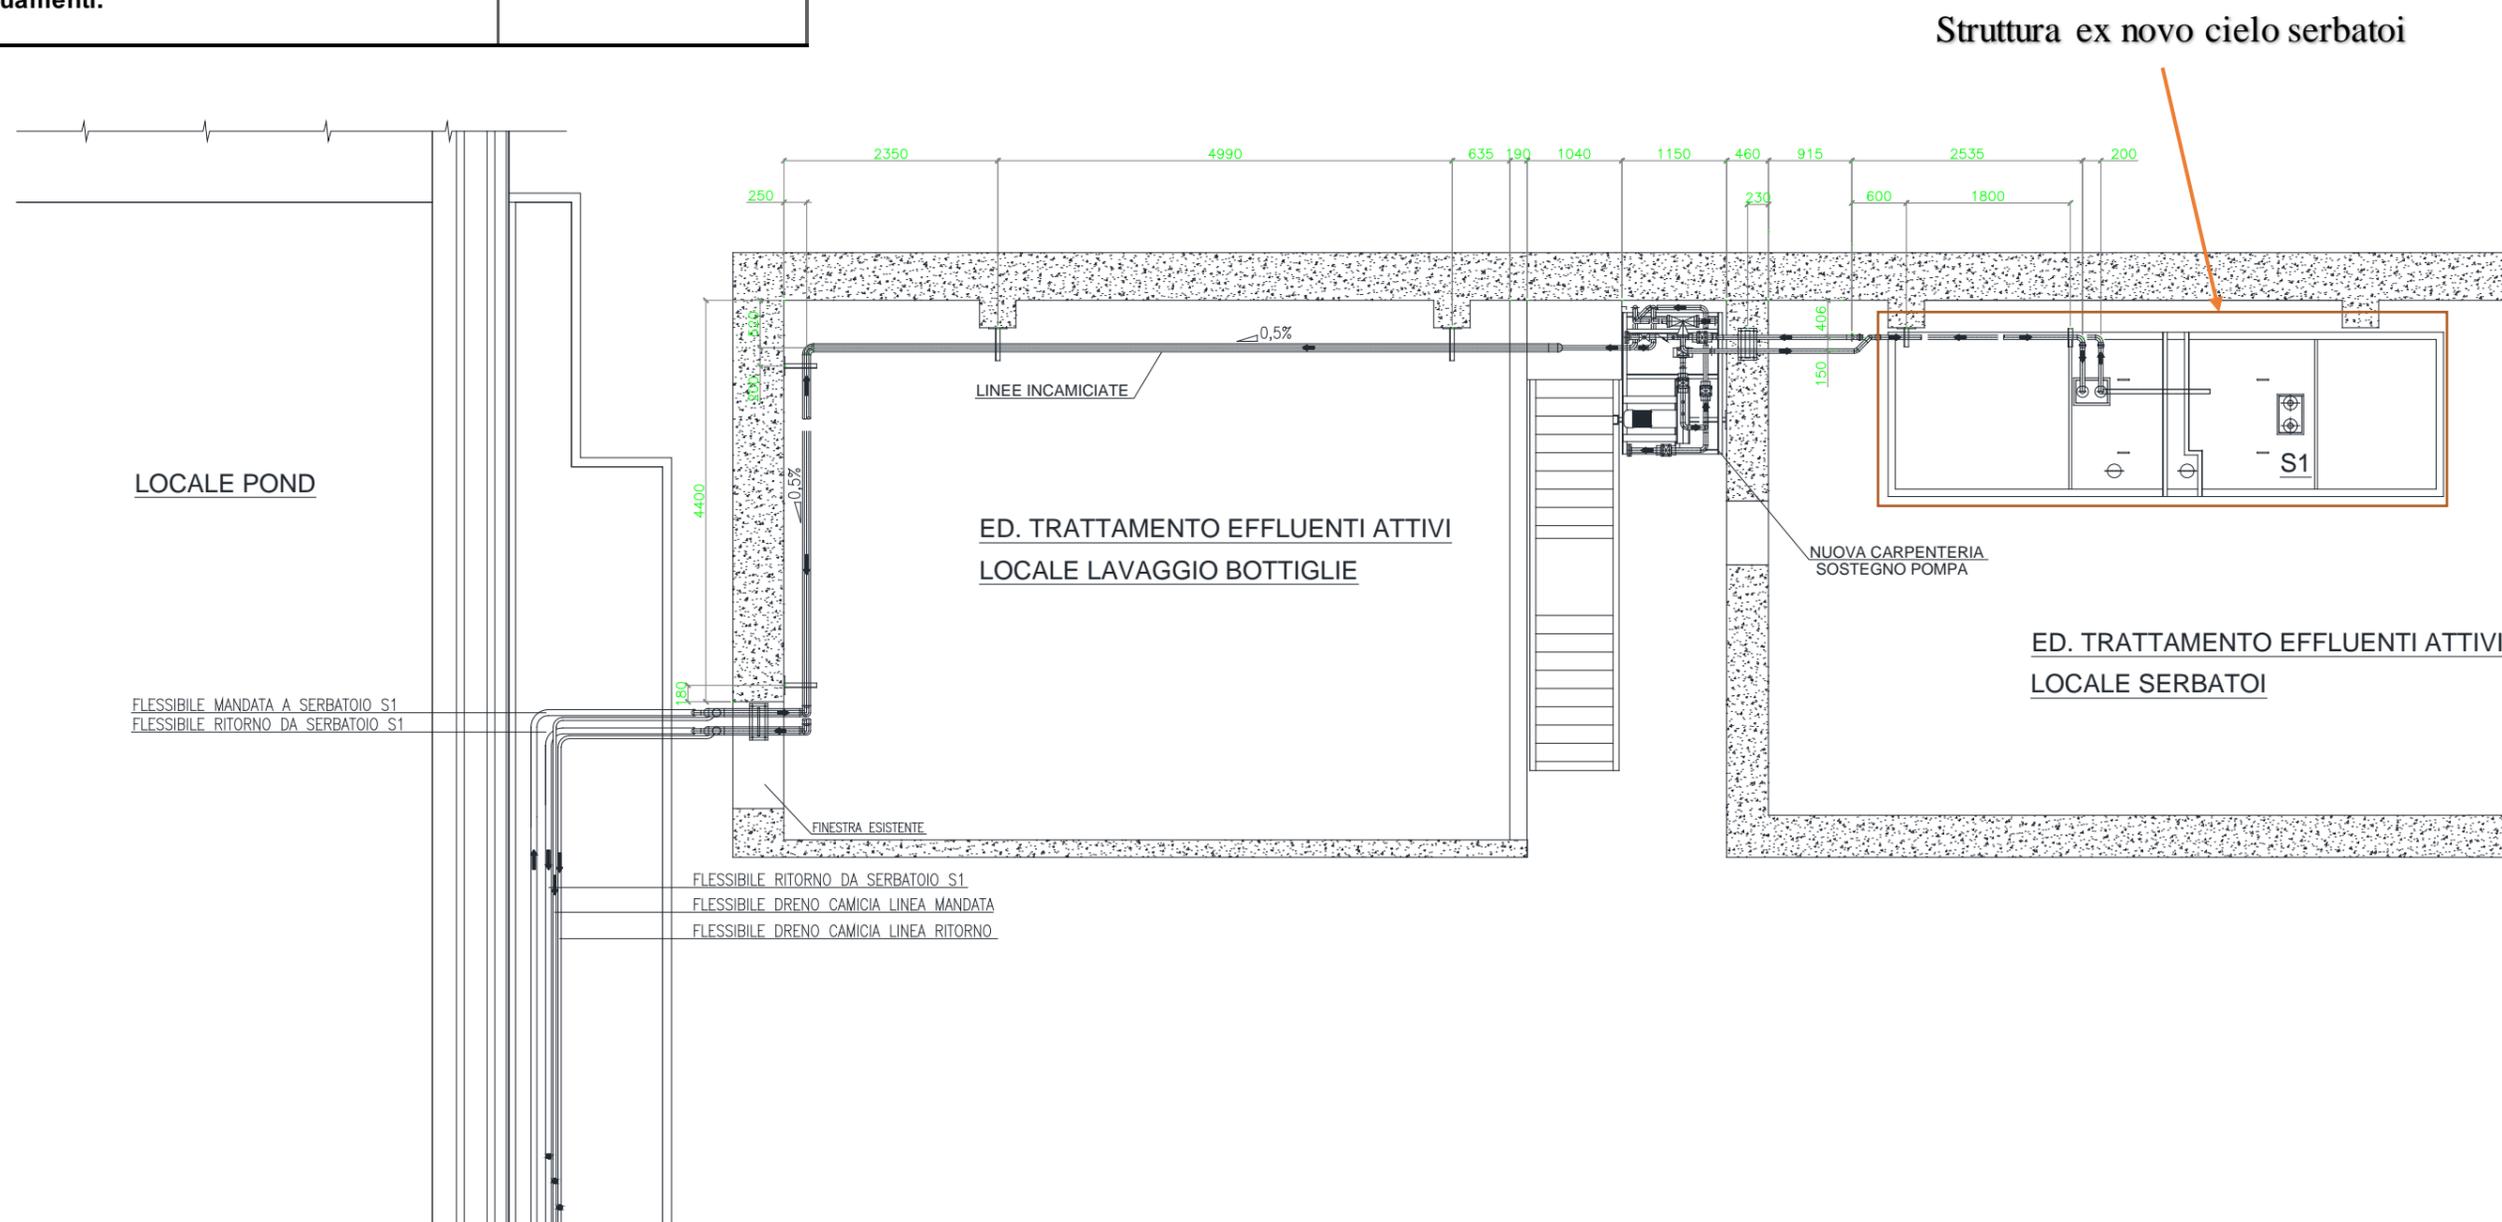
Planimetria montaggio tubazioni linee di trasferimento a serbatoio S1
